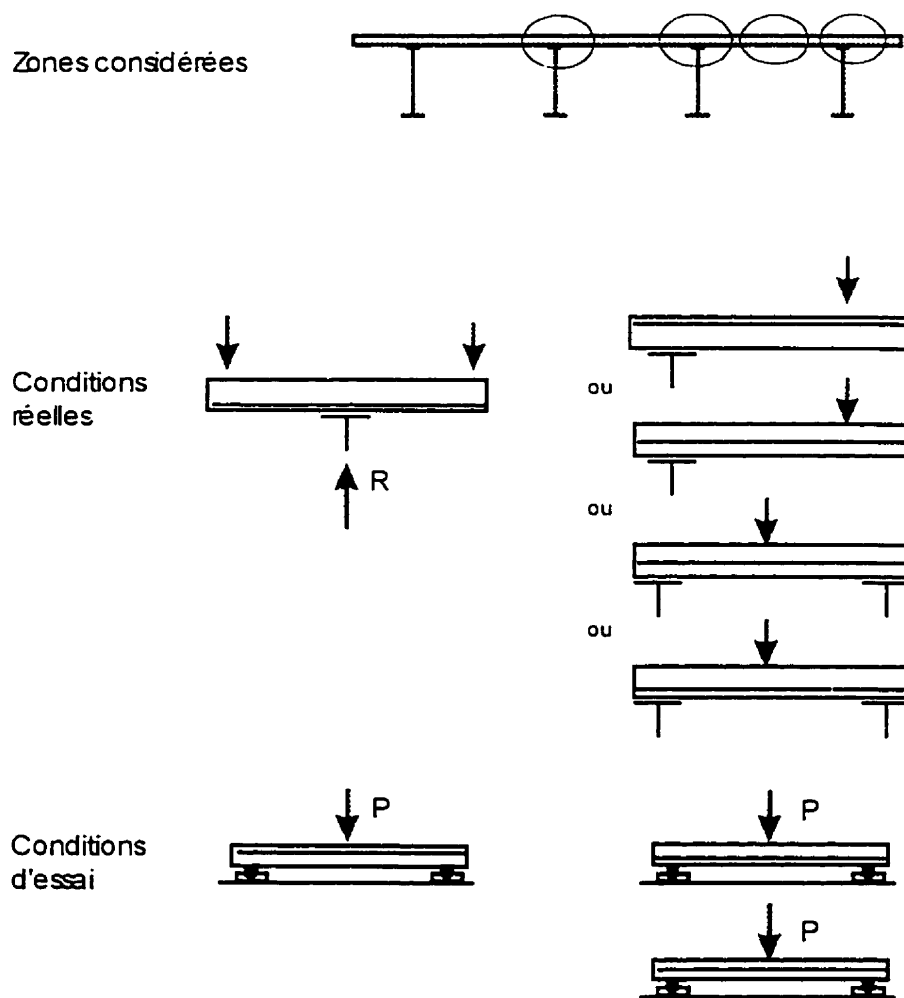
Conditions de chargement des spécimens de dalles selon les applications visées
